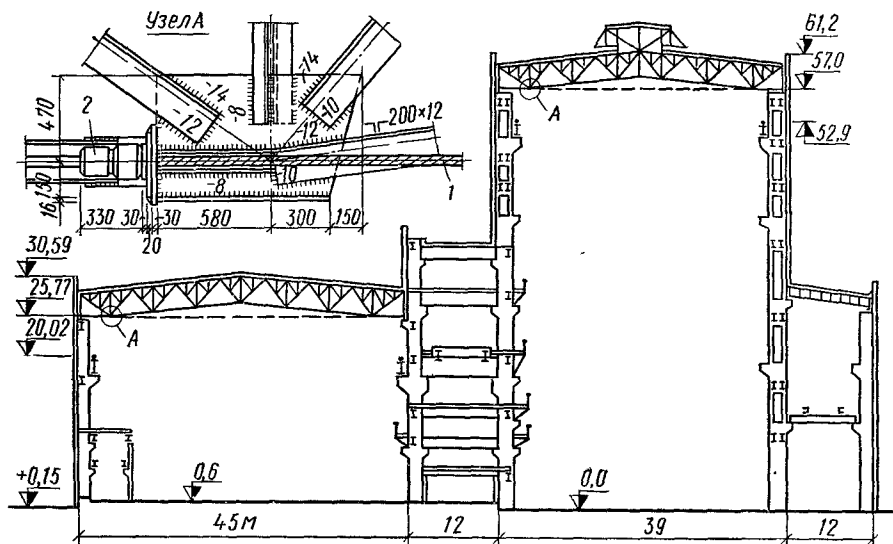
Здание ГРЭС с предварительно-напряженными фермами
